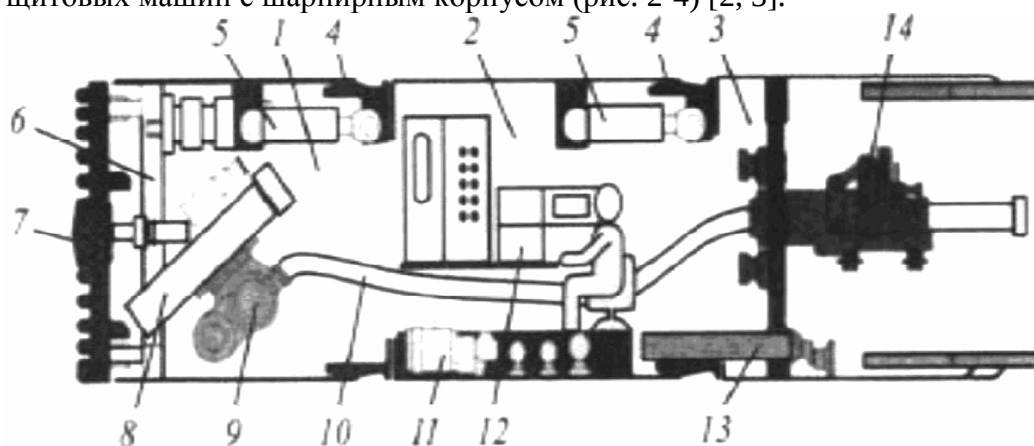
Конструктивная схема щитовой машины с шарнирным корпусом первого вида
